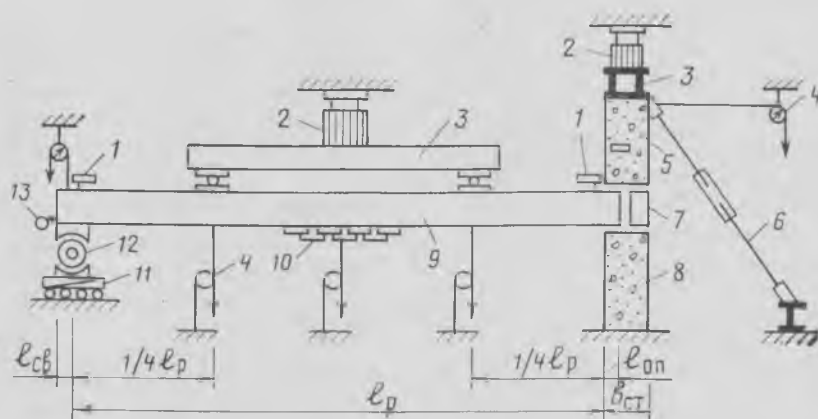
Схема испытания однопролетного фрагмента перекрытия, защемленного на опоре в блочную стену
